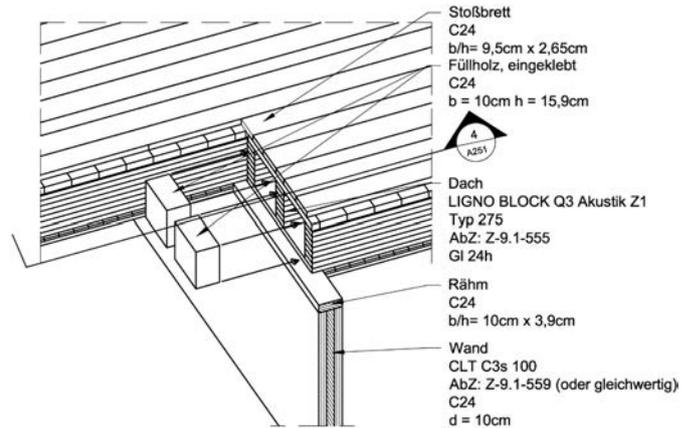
Auflager Typ 4 Dach – Wand, Isometrie
